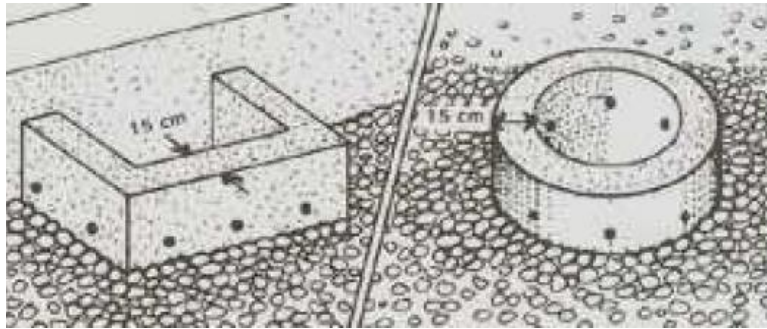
Confinamientos de hormigón para estructuras situadas dentro del pavimento
